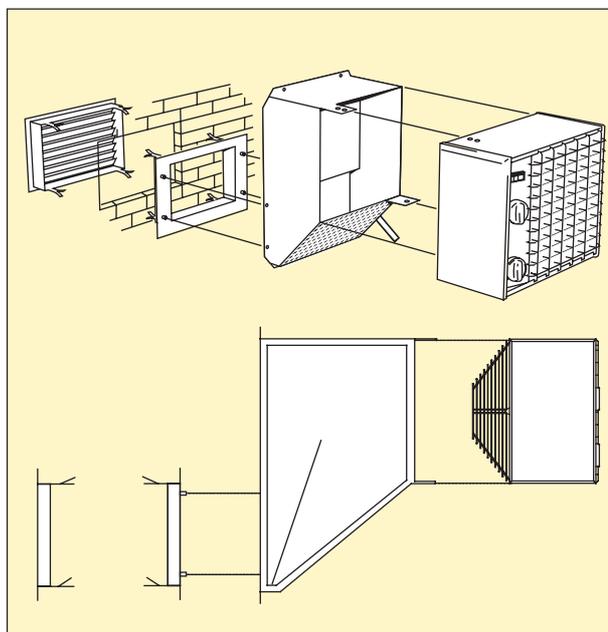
Общий вид и поперечный разрез при установке тепловентилятора Cat с камерой смешения
